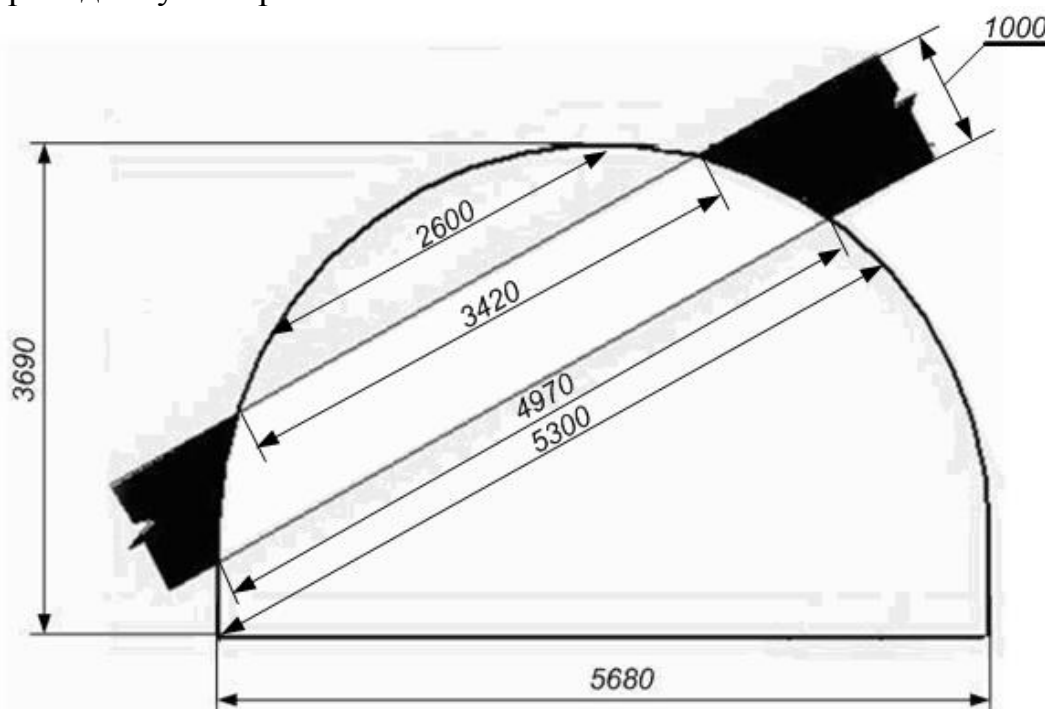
Схема для определения площадей угольного и породных забоев
